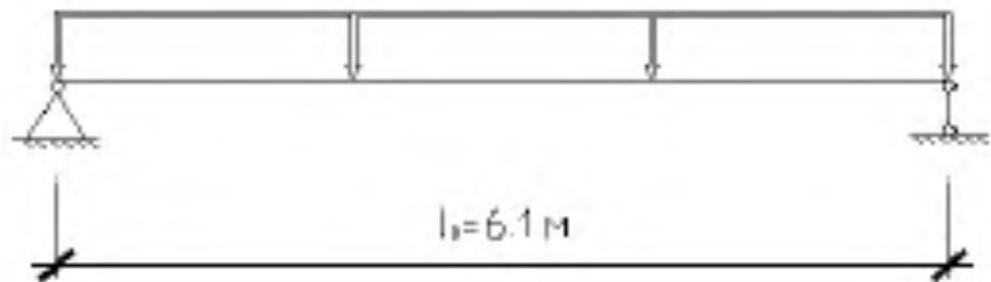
Схема завантаження багатопустотної панелі перекриття.
